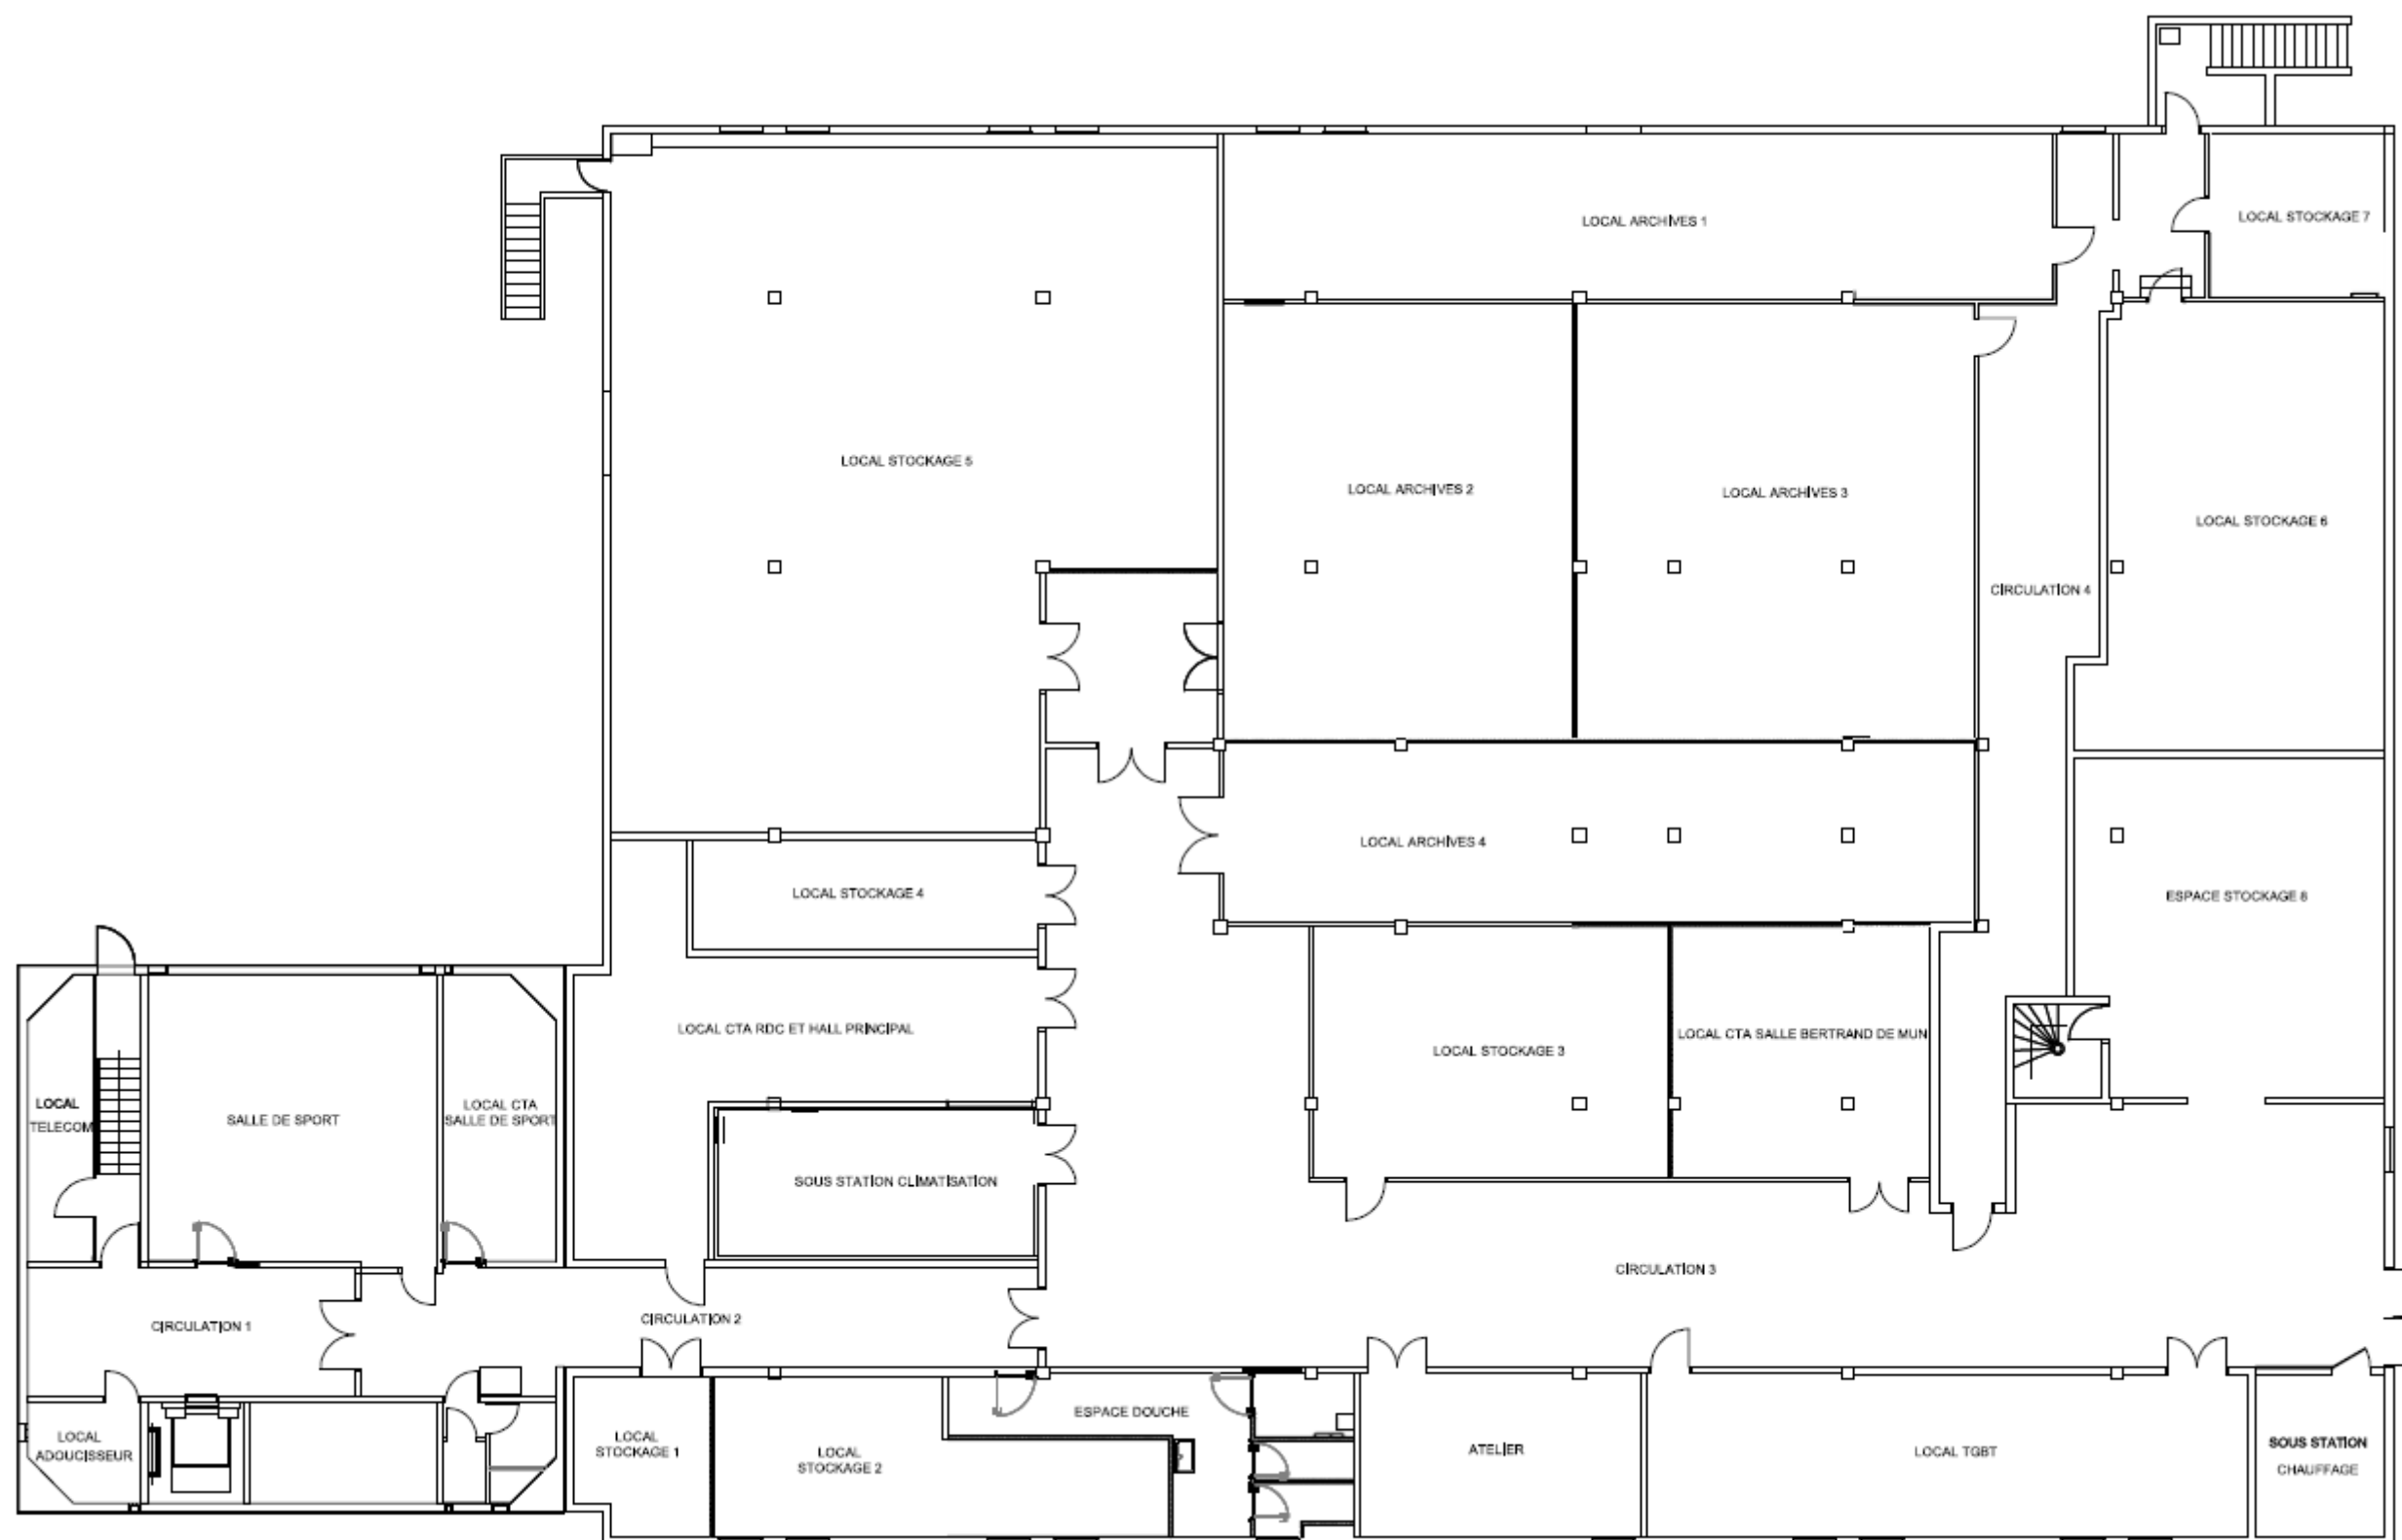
plan de masse du sous-sol du bâtiment principal (source CCIT Marne-Ardenne))
